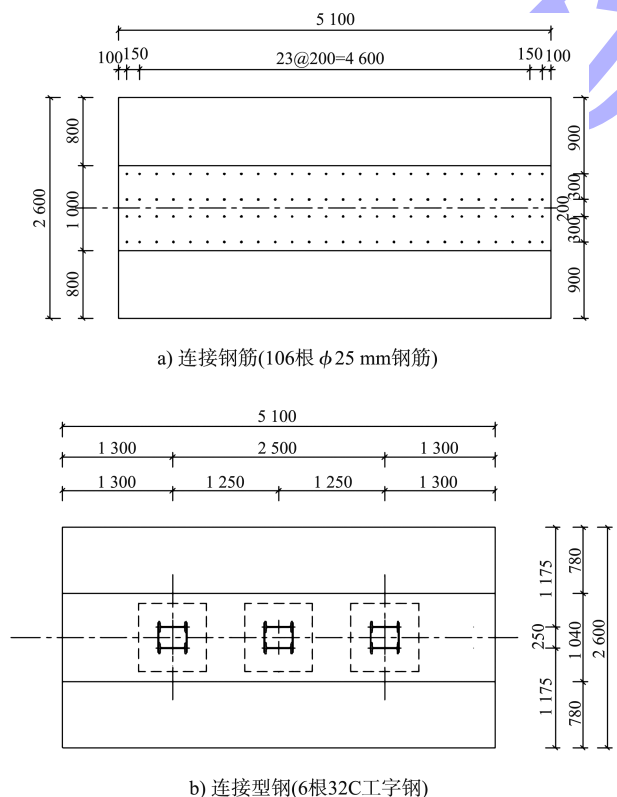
两种模型连接配筋 (型钢) 情况 (单位: mm)
